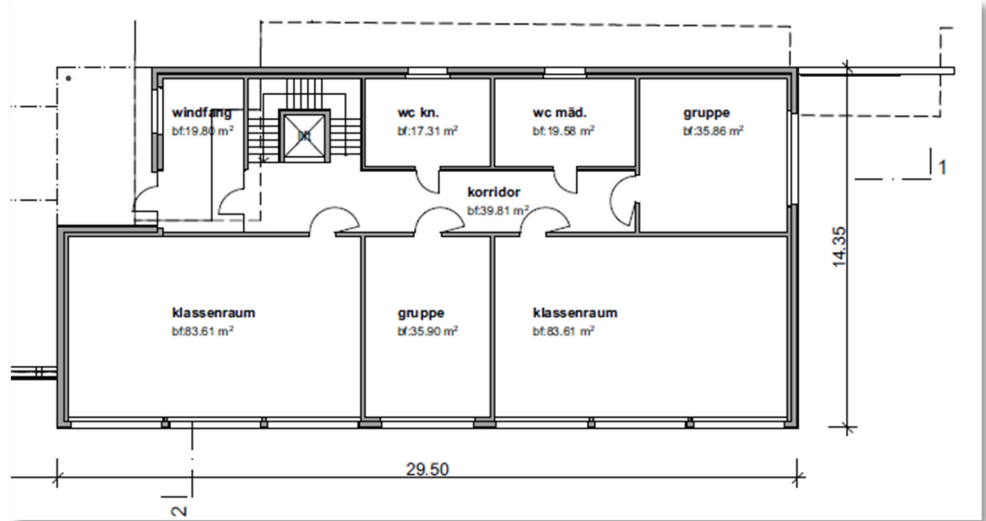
EG-Grundriss Standort 3 «Neubau Quer» gemäss Machbarkeitsstudie, 2025 [1]
